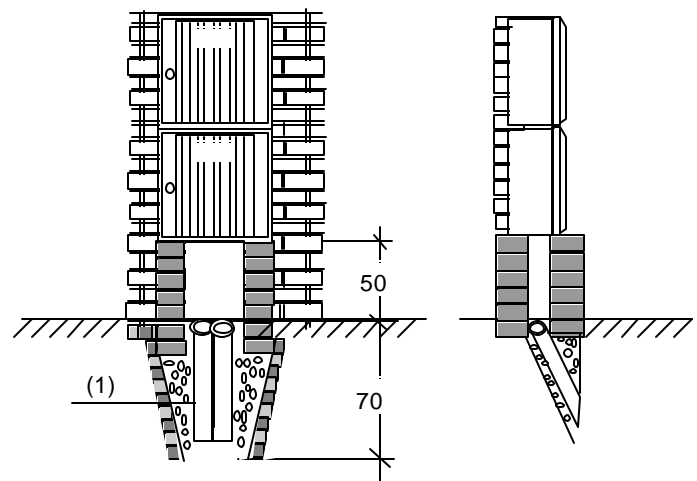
c) Montaje del conjunto de CPM y caja de seccionamiento
